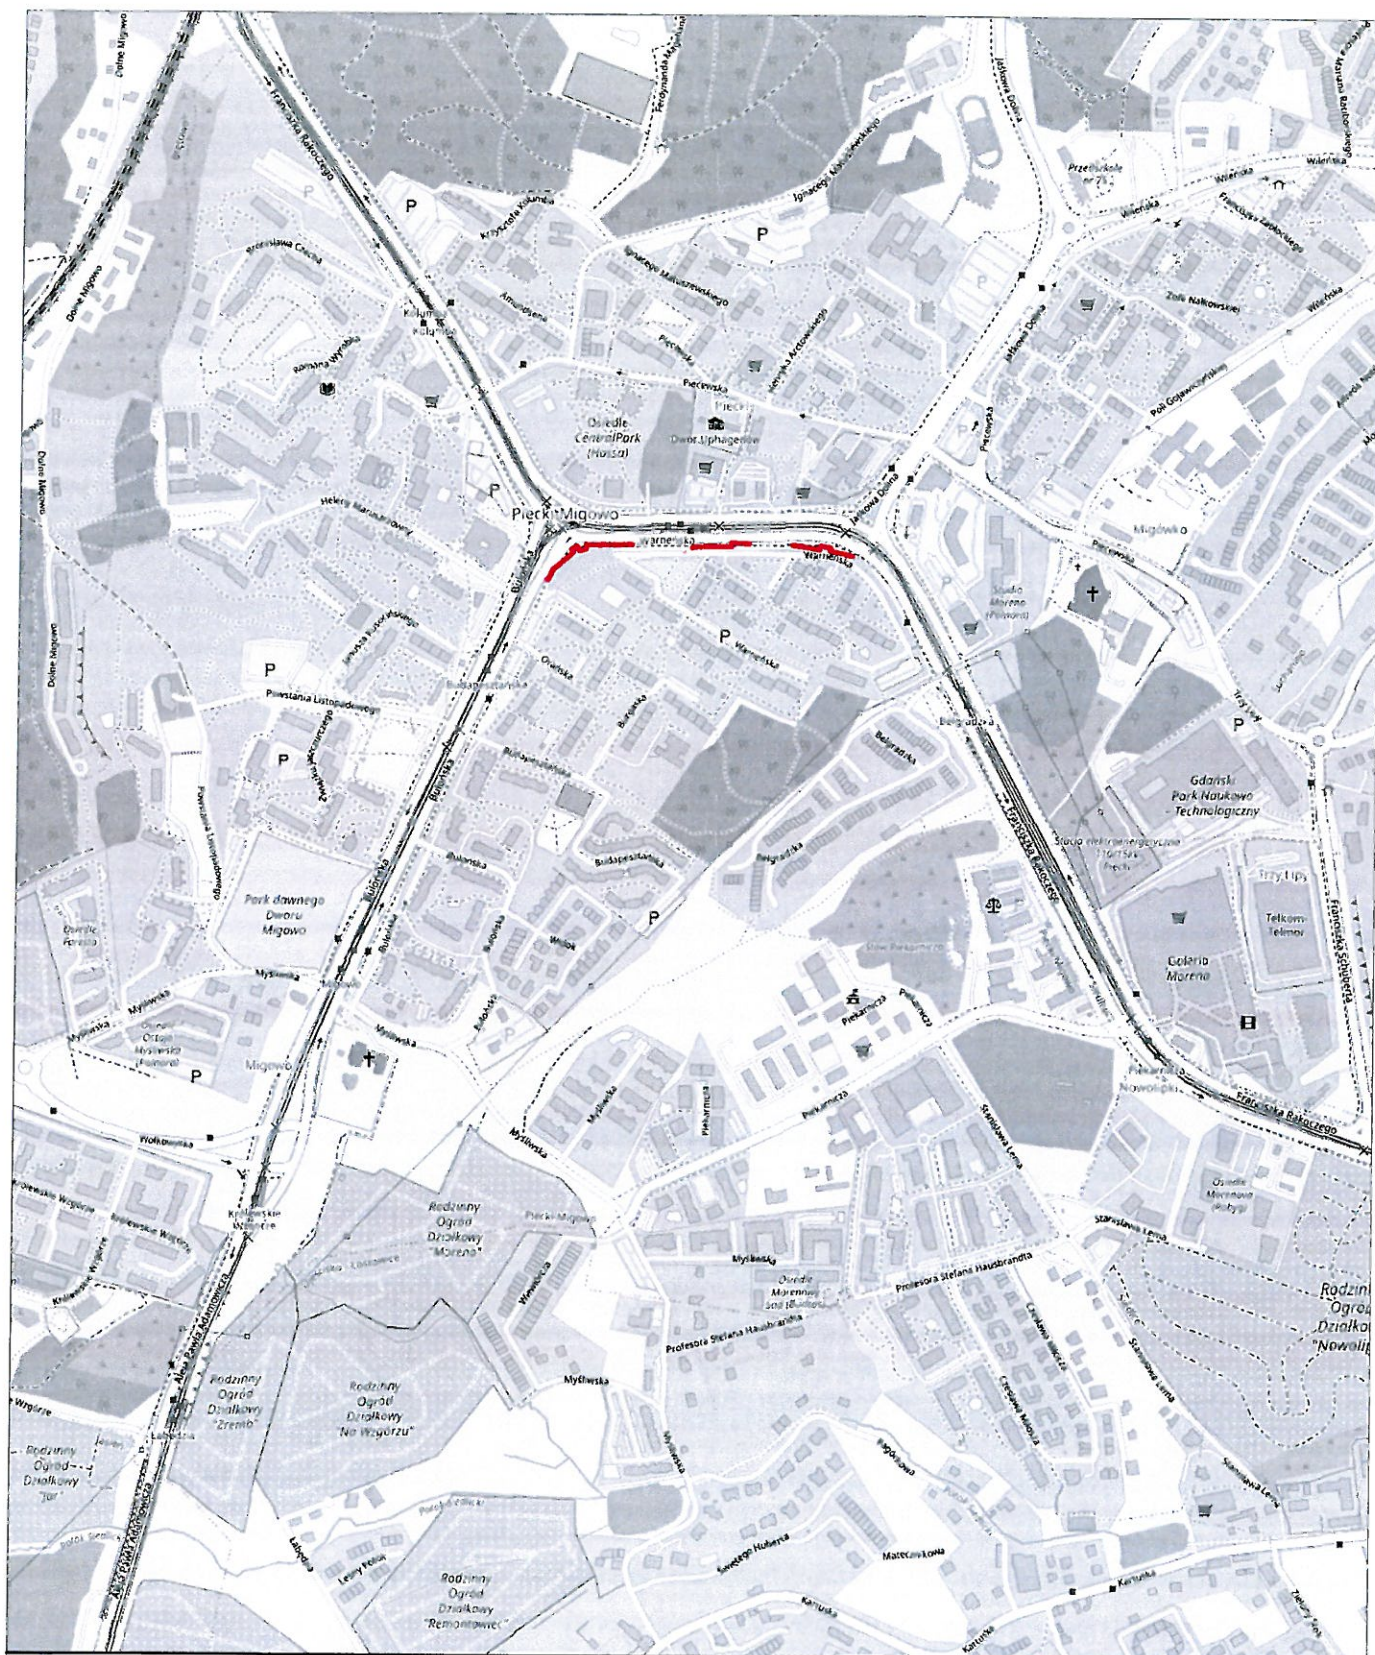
Ark. 3/7 – plan sytuacyjny: ETAP III
